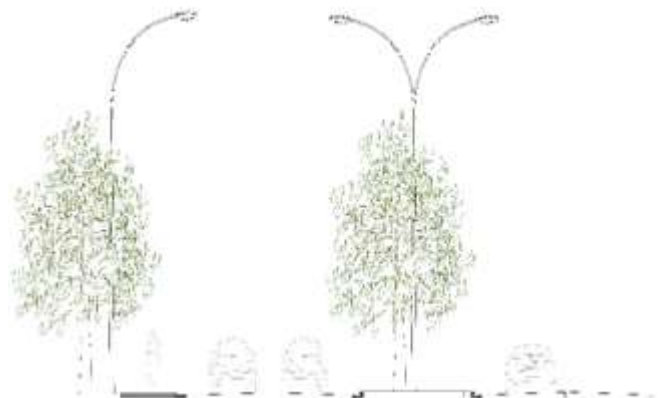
Diagrama del Perfil vial Av. Bolívar. Fuente: El Autor (2022)
